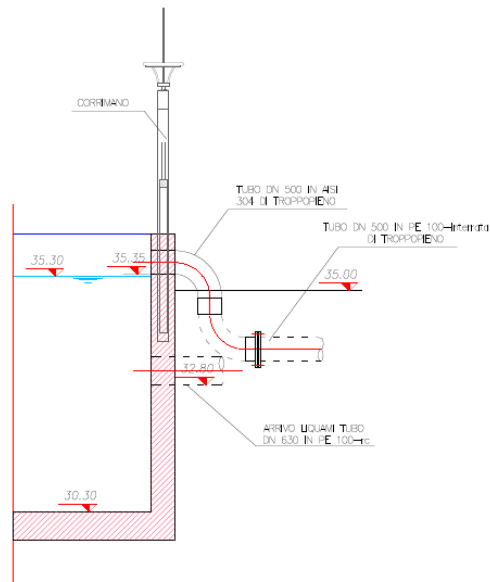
Pianta e sezioni nuova vasca di equalizzazione con copertura
